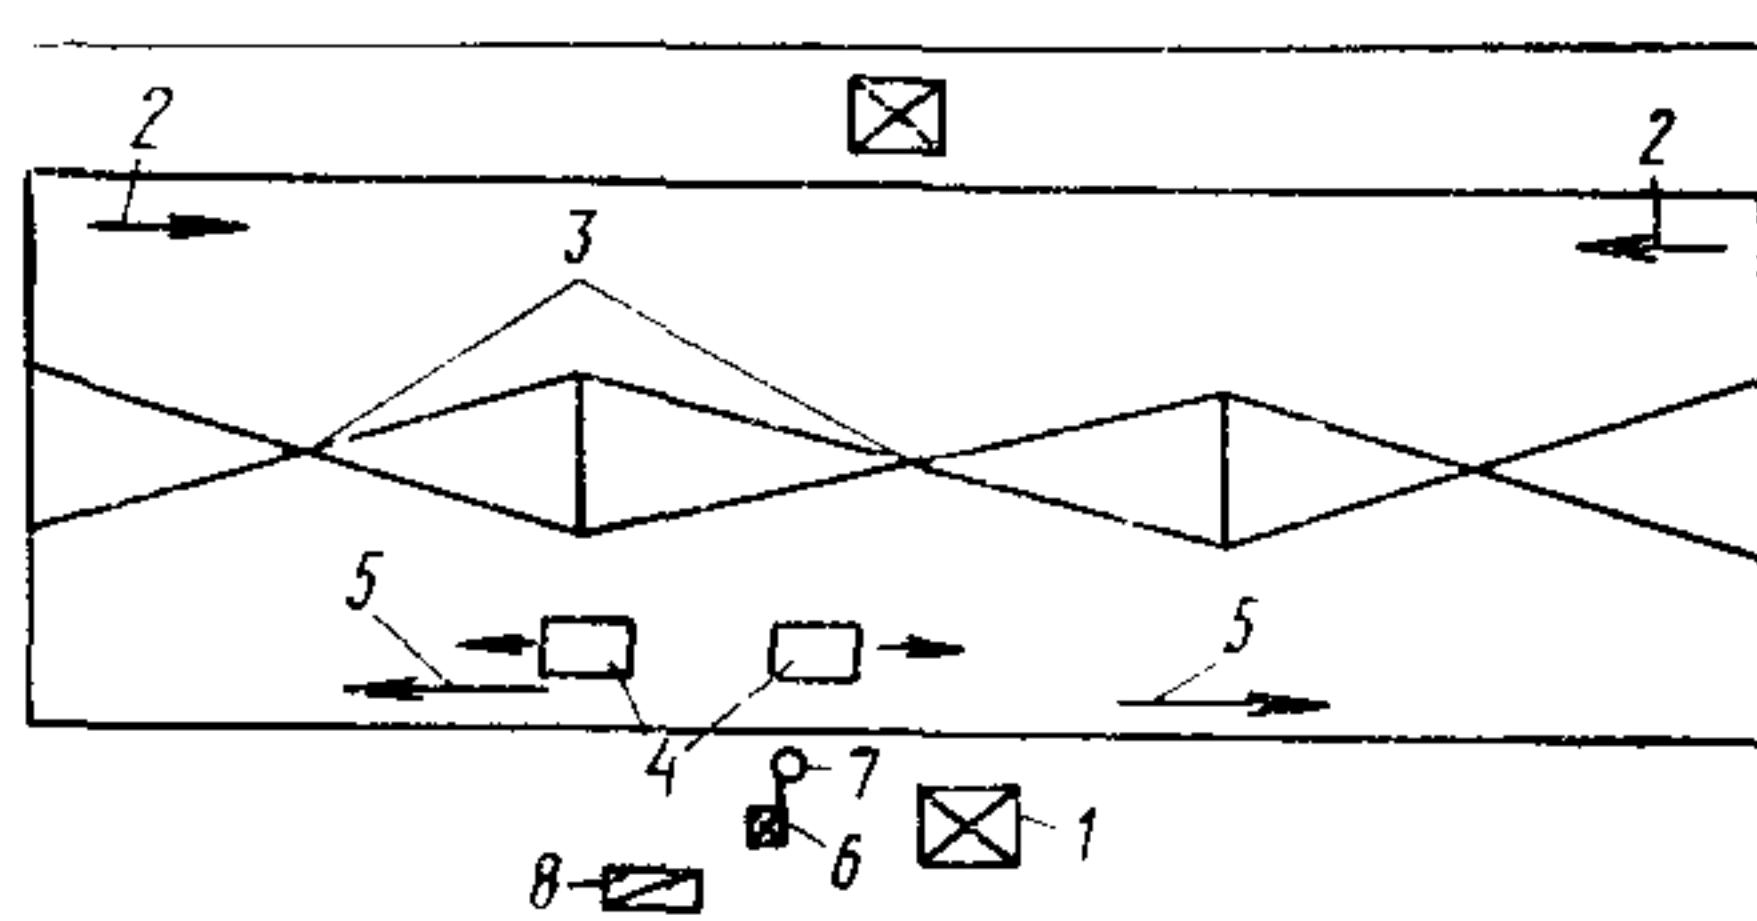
Схема организации производства кровельных работ на крыше промышленного здания
